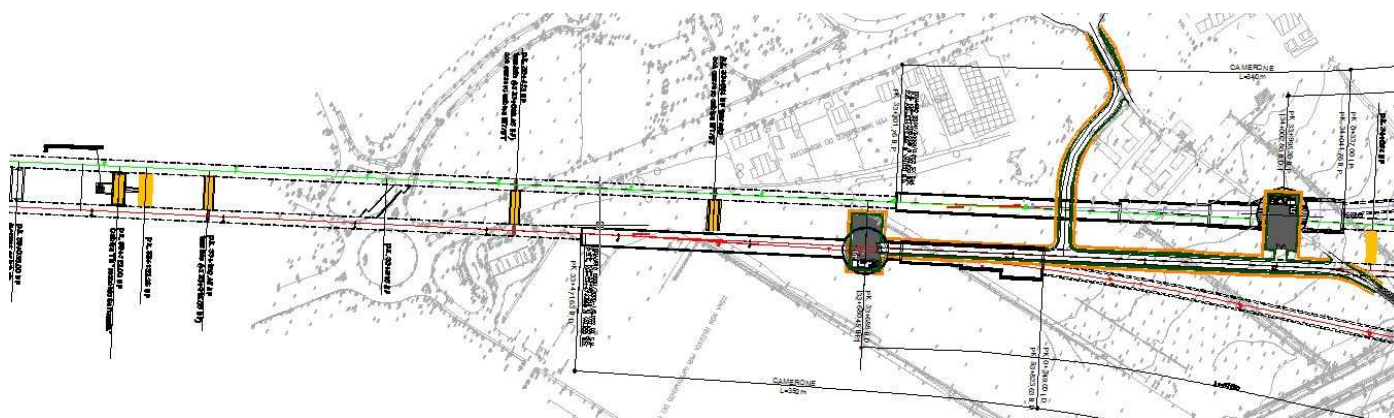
Schema planimetrico by-pass aggiuntivi Galleria di Serravalle con passaggi a raso
